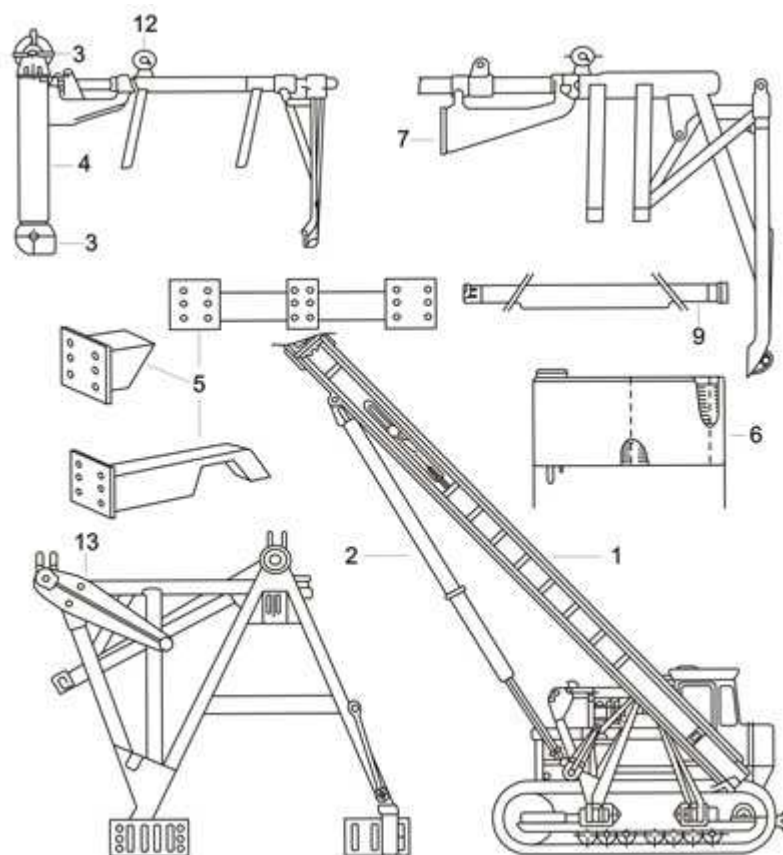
Схема конструкции сваебойной установки СП-49
